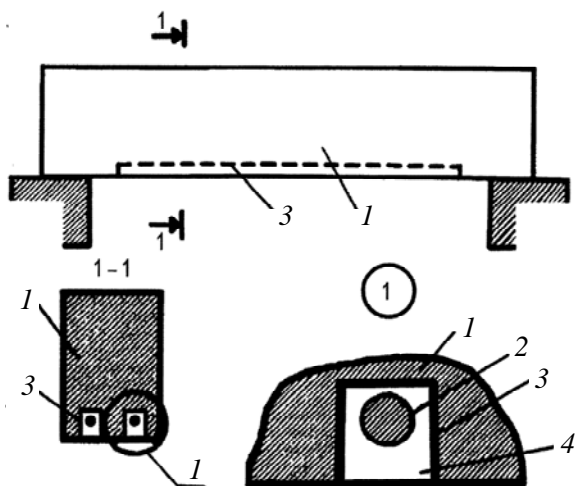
Усиление балки установкой дополнительной арматуры на полимеррастворе:
